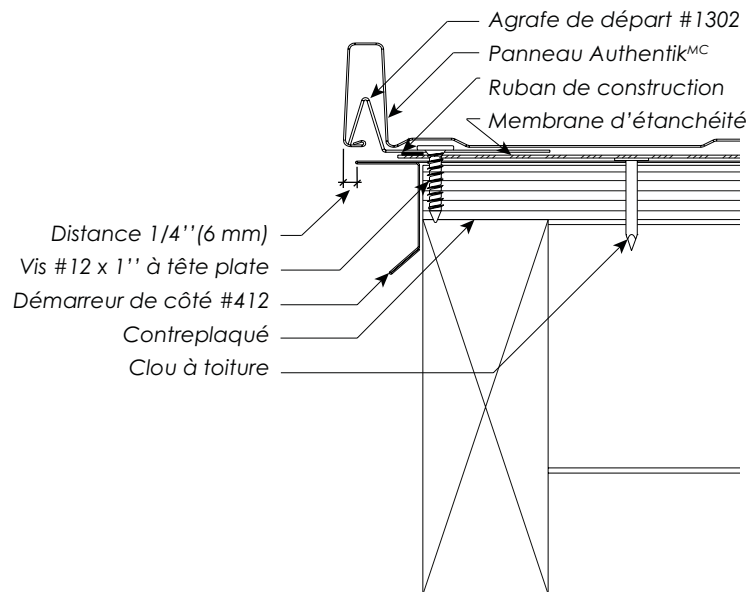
a | Vue en coupe du départ de pignon – méthode 1
